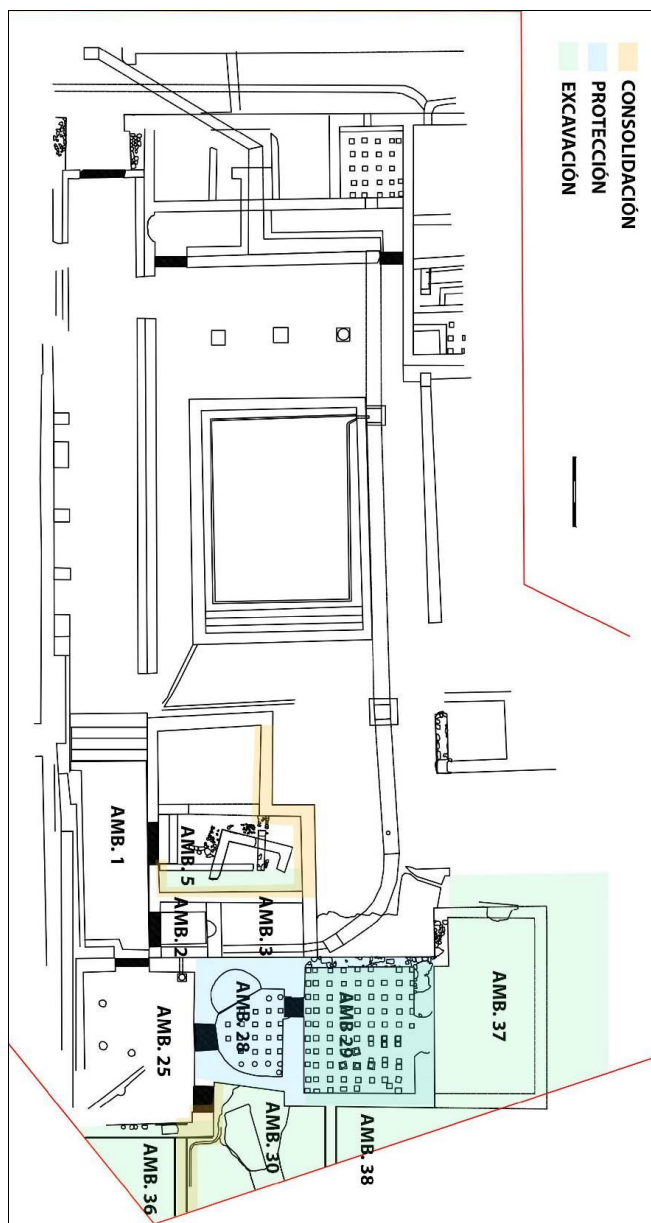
Planta del Sector 7F con indicación de las zonas de intervención
